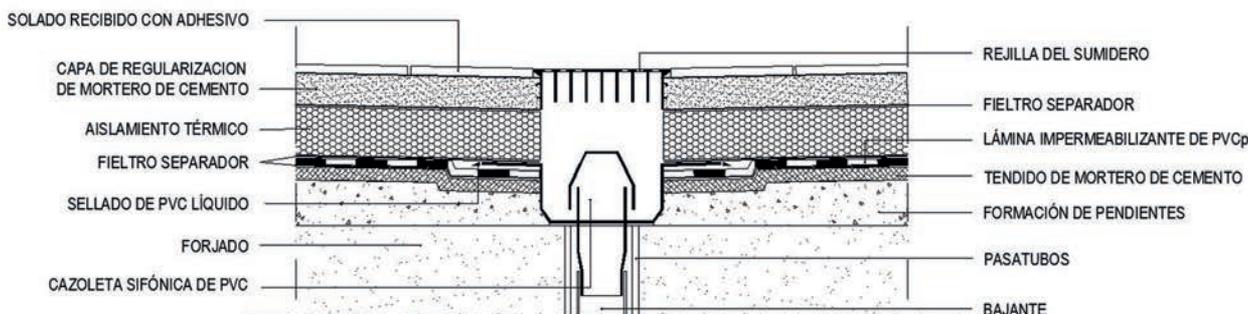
solución constructiva para un encuentro de cazoleta de PVC de ala flexible con una lámina de PVCp (cubierta invertida transitable).
